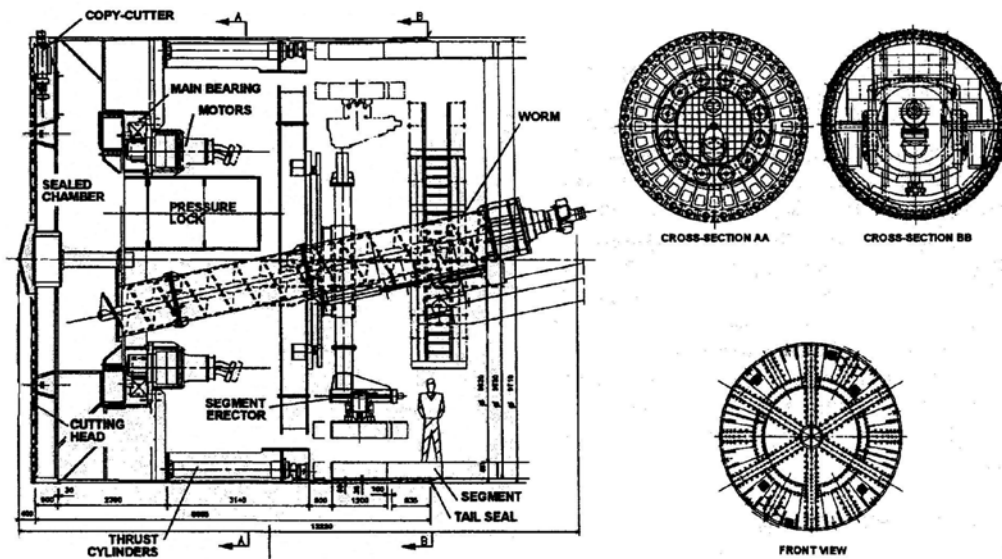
Cortes longitudinal e transversais do escudo usado na escavação dos troços Cais do Sodré – Baixa/Chiado – Rossio (Linha Verde) e Restauradores – Baixa/Chiado – Terreiro do Paço – Santa Apolónia (Linha Azul) (Bosco e Correa, 1998)
